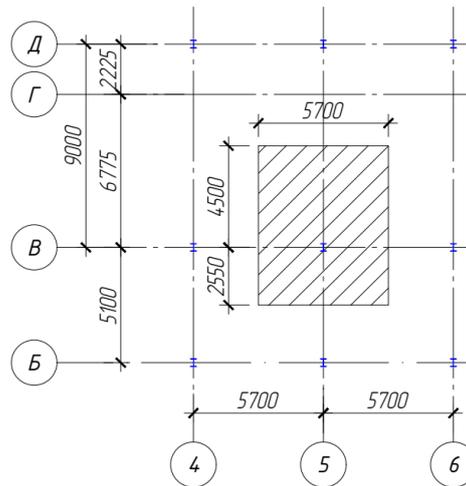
Грузовая площадь колонны в осях 5/В
